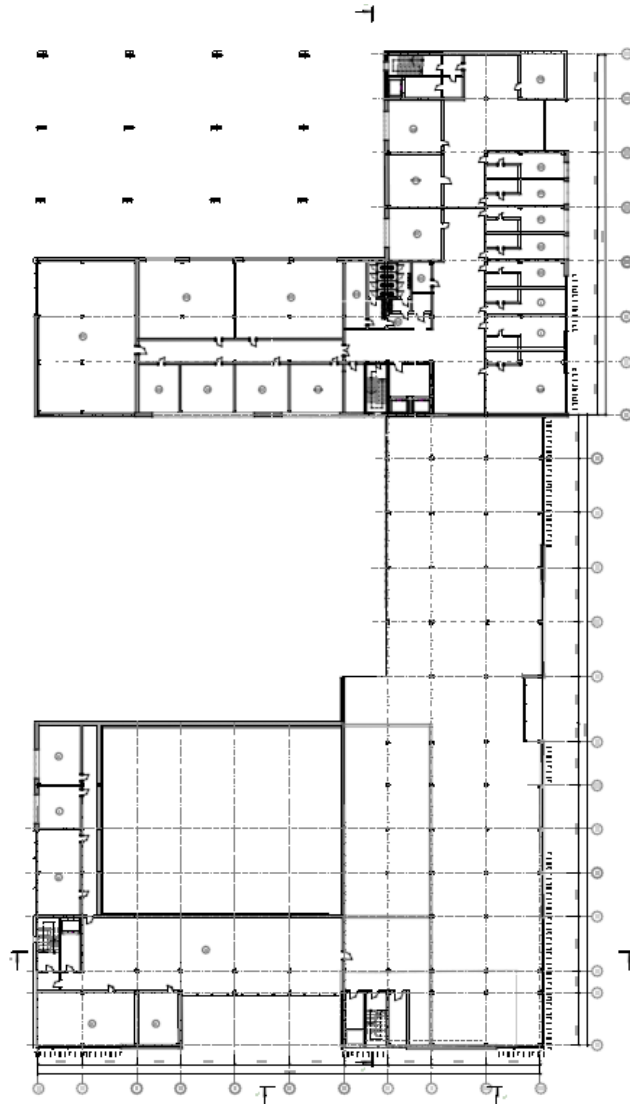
План третього поверху (на відмітці +7.800)
